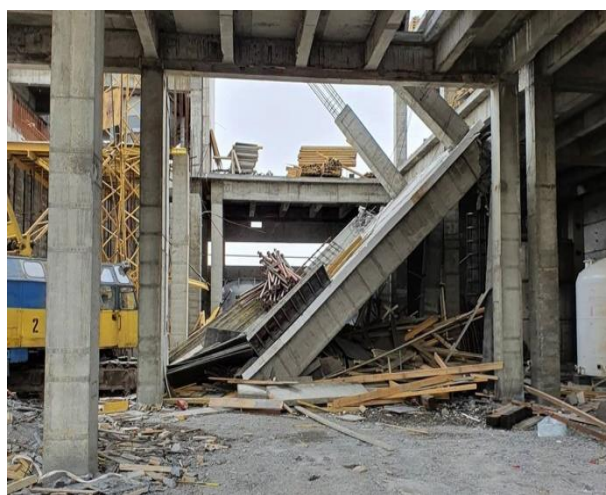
Примеры обрушения несущих конструкций перекрытия монолитных каркасных зданий
